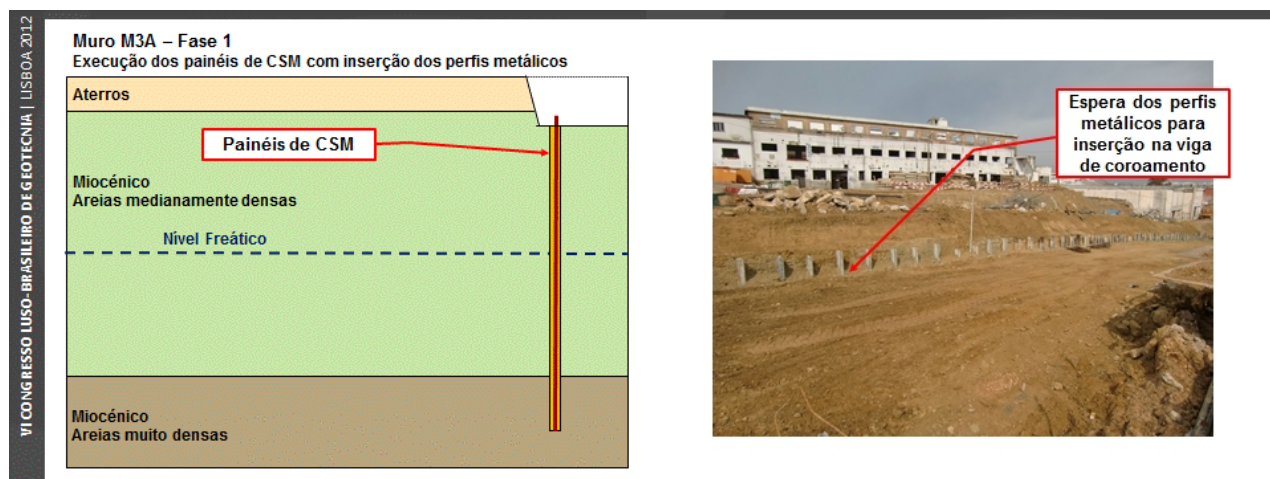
Fase 1 do faseamento construtivo do Muro M3A
